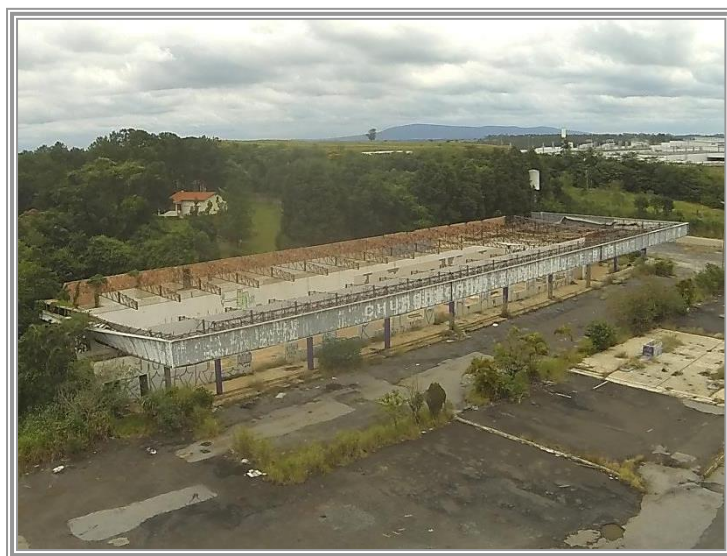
(↩): Pela imagem aérea são vistas as estruturas metálicas que sustentavam o telhado do restaurante.
